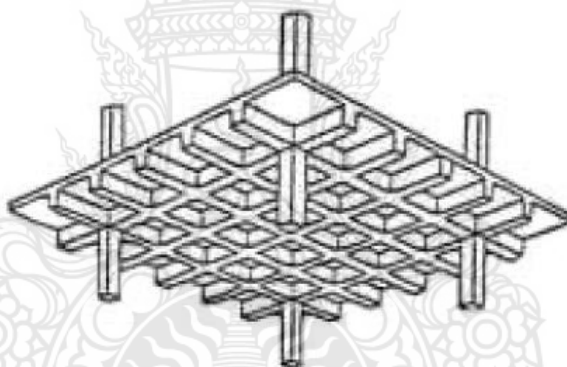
พื้นระบบ Post tension แบบ Beam and Slab [14]
